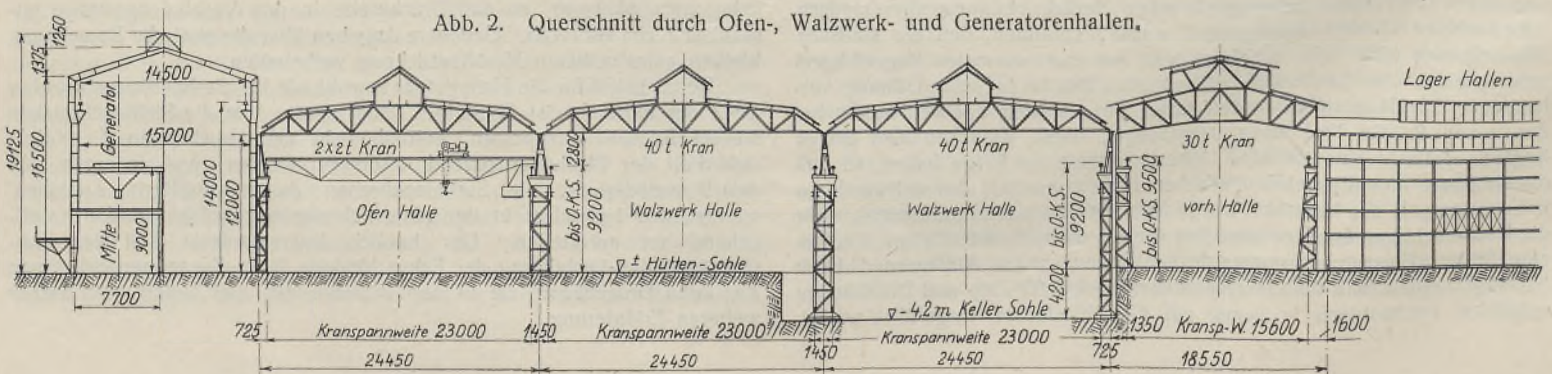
Querschnitt durch Ofen-, Walzwerk- und Generatorenhallen.
